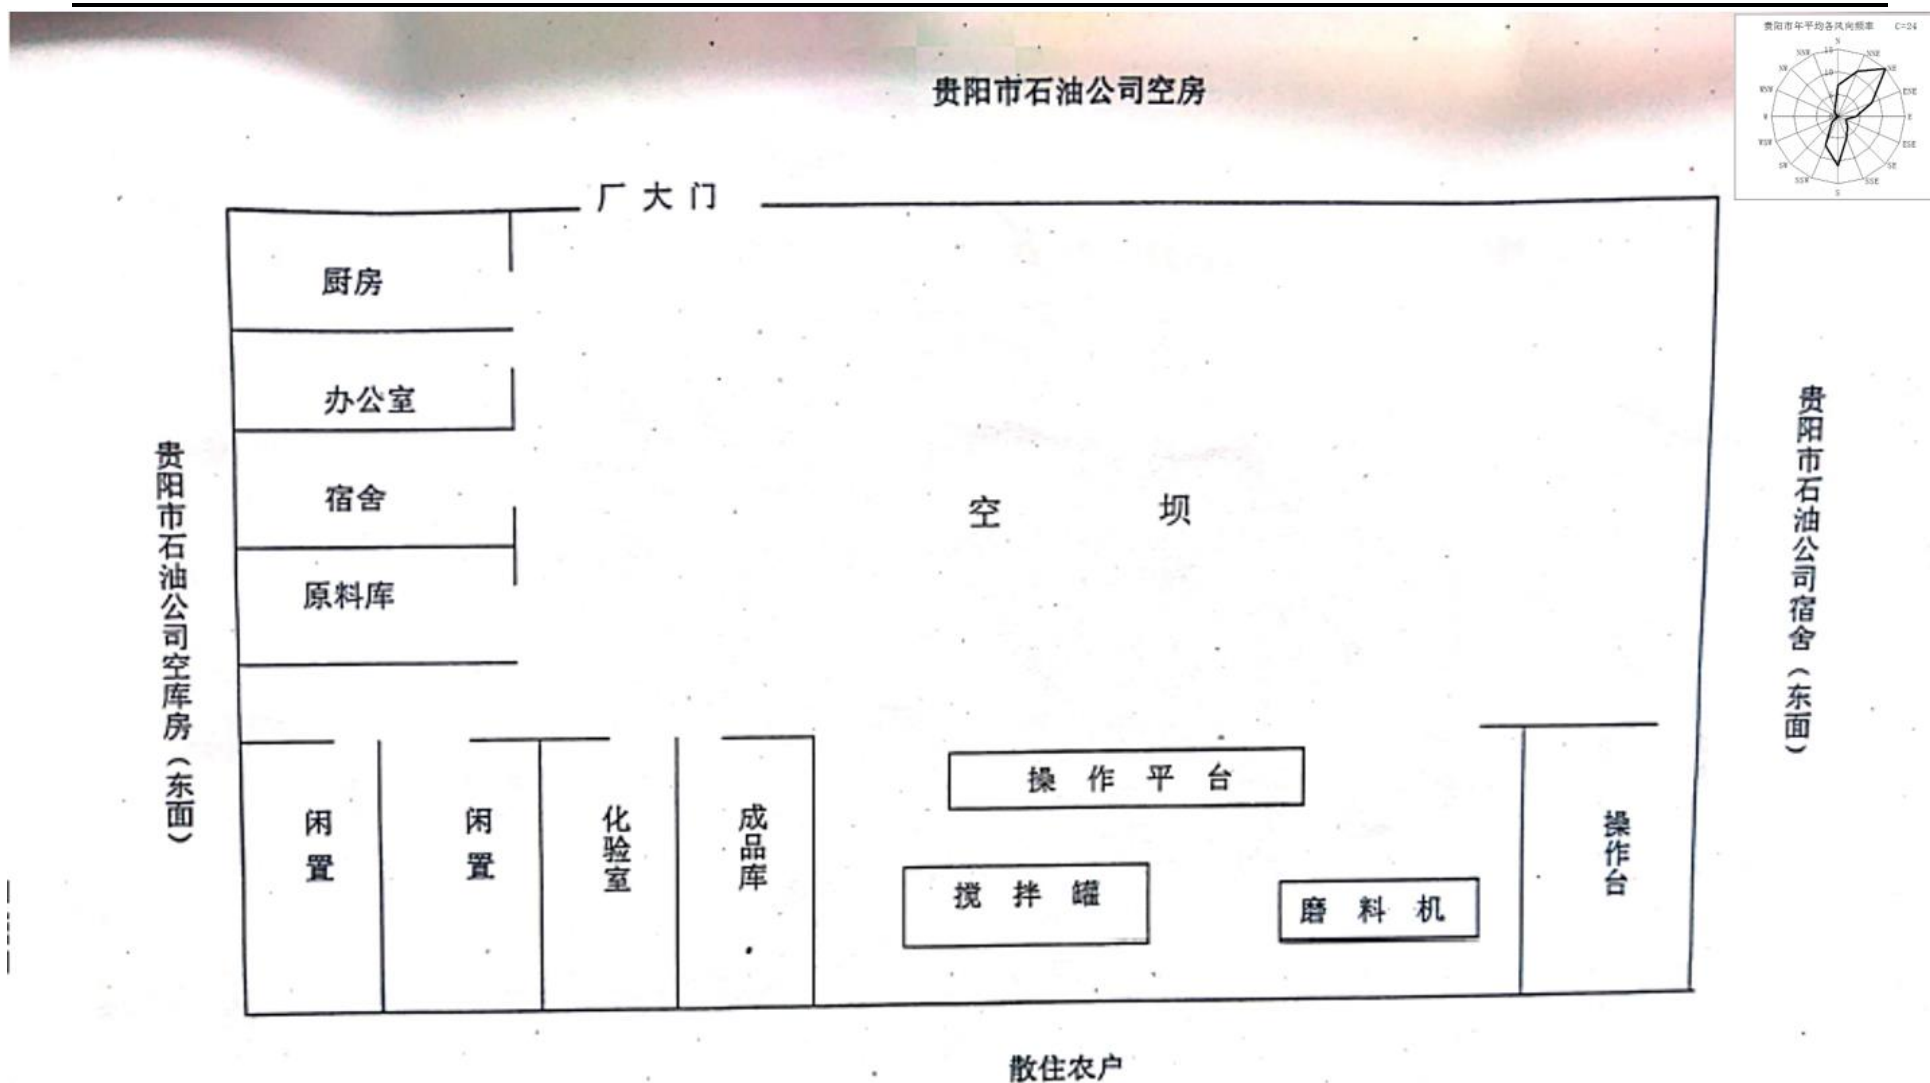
贵阳凯泰化工科技发展有限公司厂区平面布置示意图
